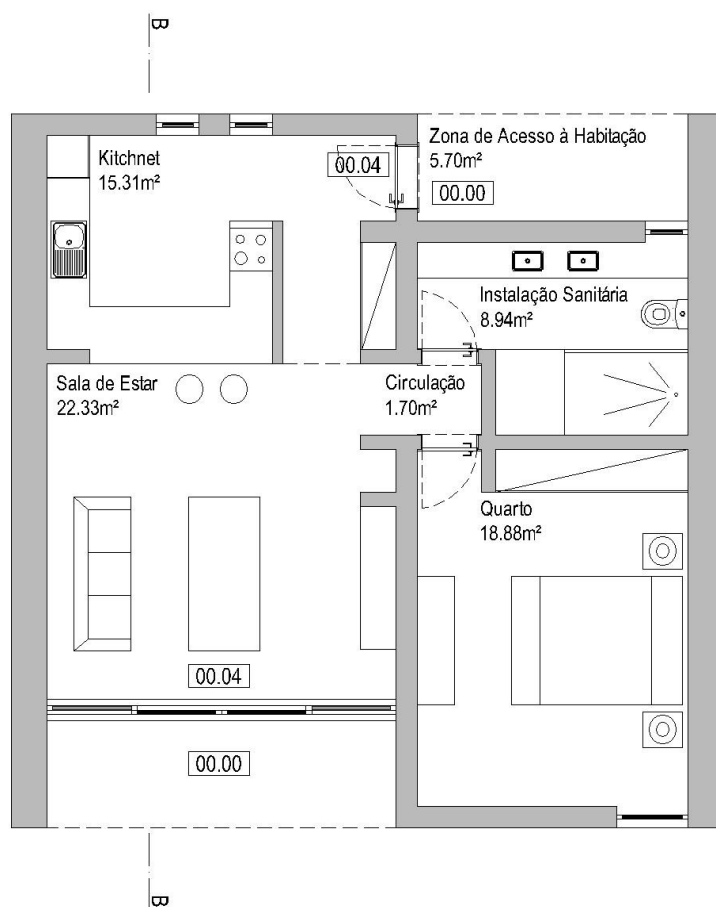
Planta do piso 0 – Módulo Habitacional⁶⁷
